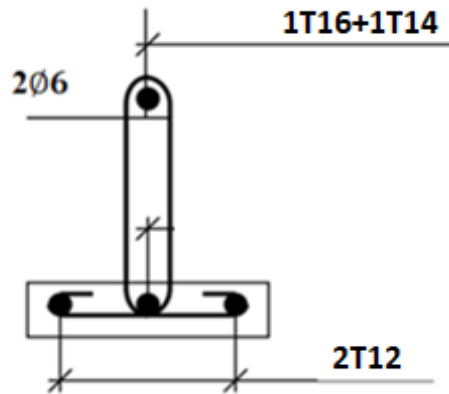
Schéma du ferrailage des poutrelles
